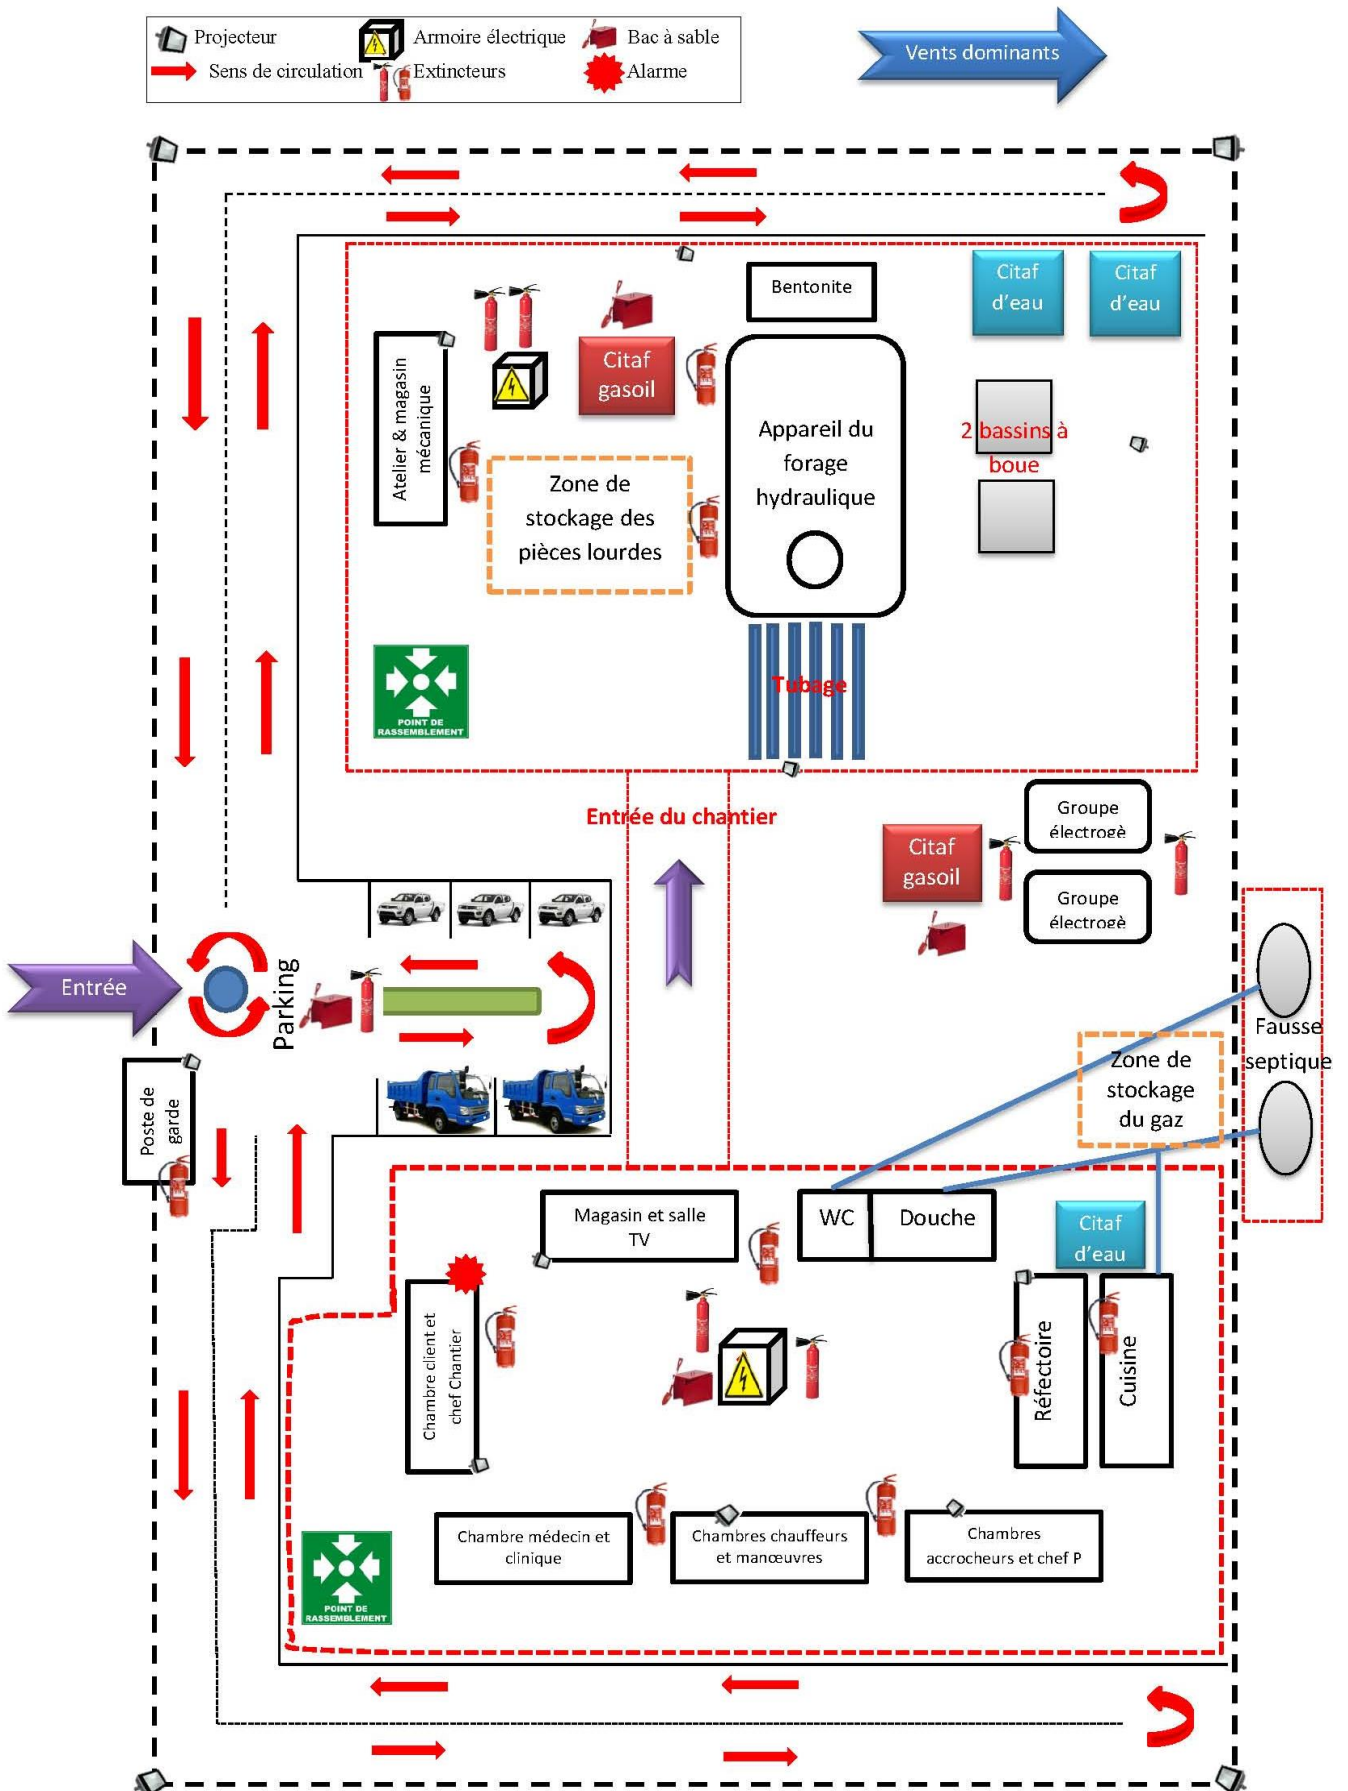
Plan de masse d'un chantier de forage hydraulique.
